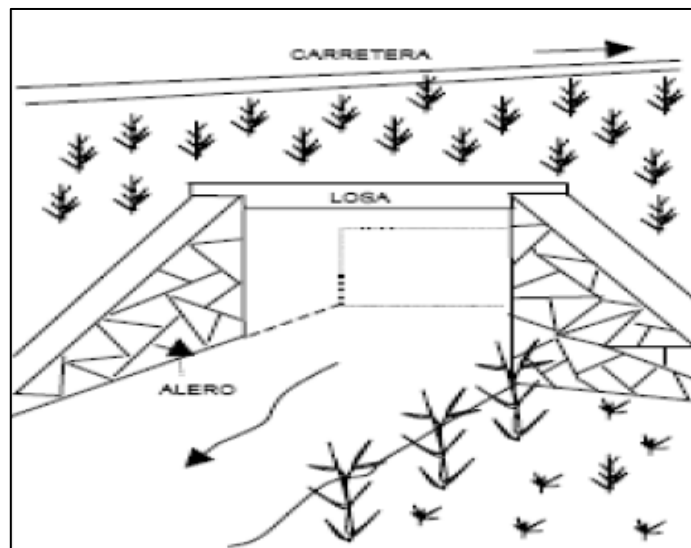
Alcantarilla Típica. Losa de Concreto
